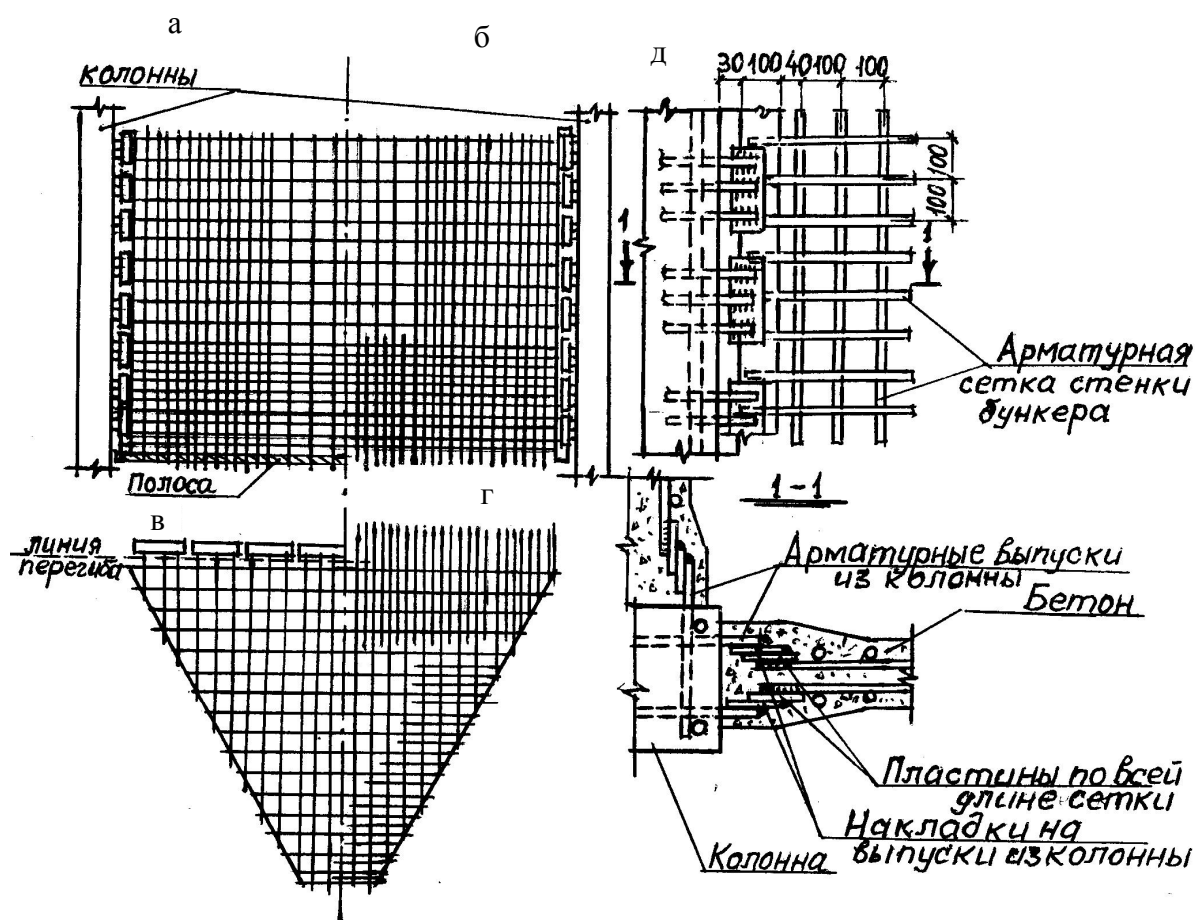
Армирование стенок монолитного бункера:
